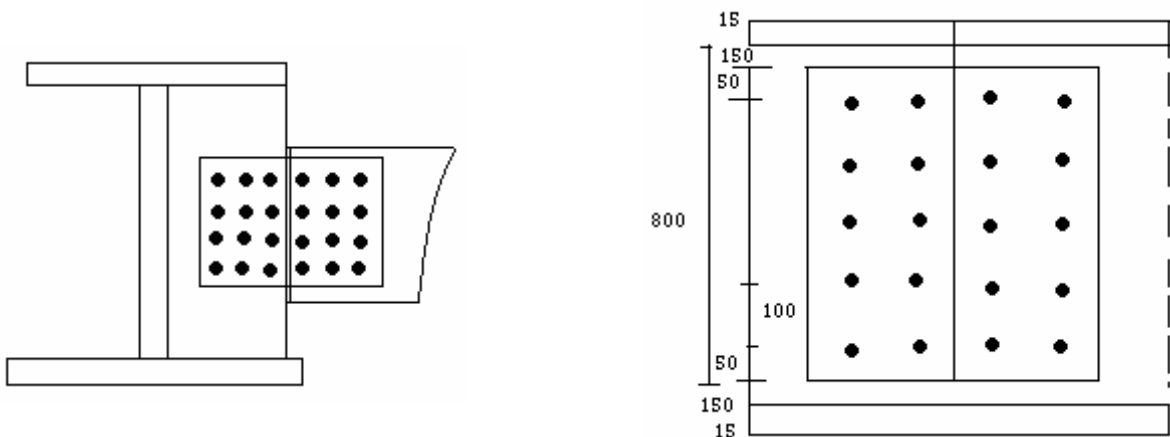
Assemblage de l'entretoise à la culée gauche avec les poutres principales
